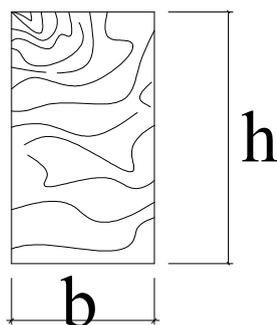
Деревянная балка: h – высота балки; b – ширина балки
